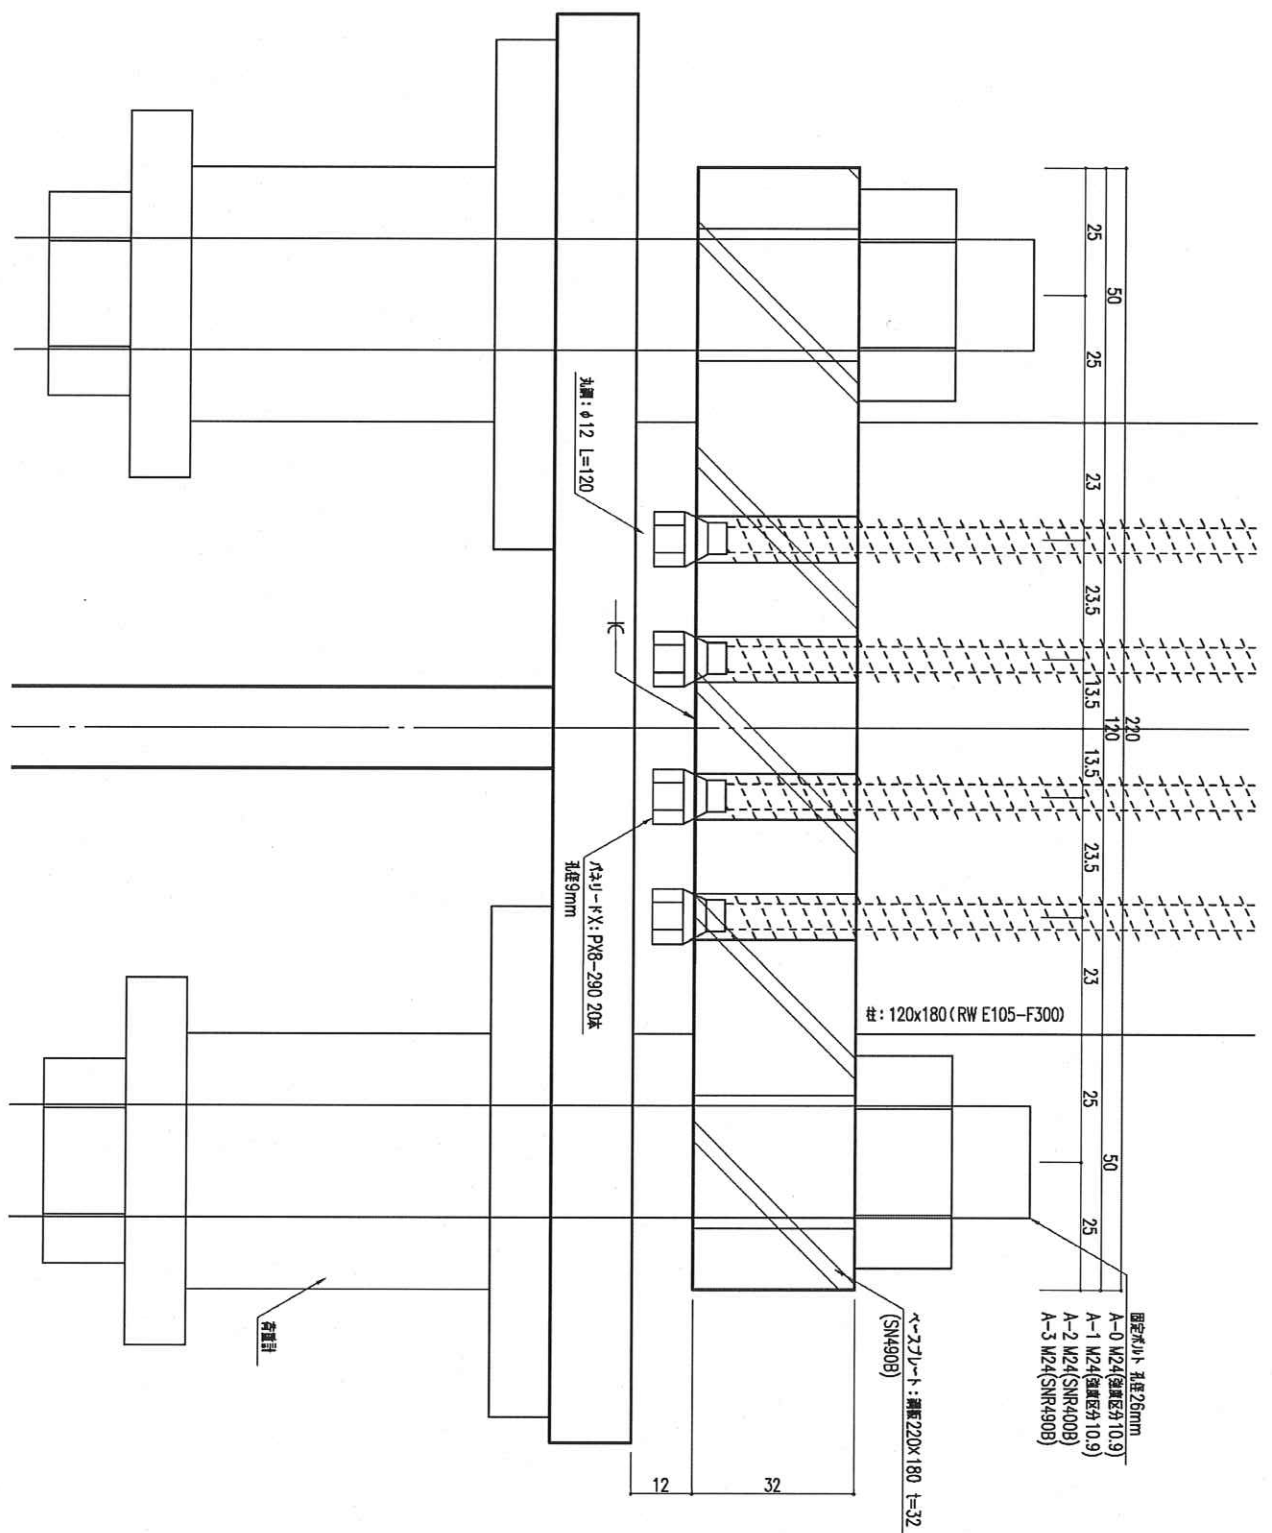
試験法 A 柱脚金物詳細図 (側面) (単位: mm)
